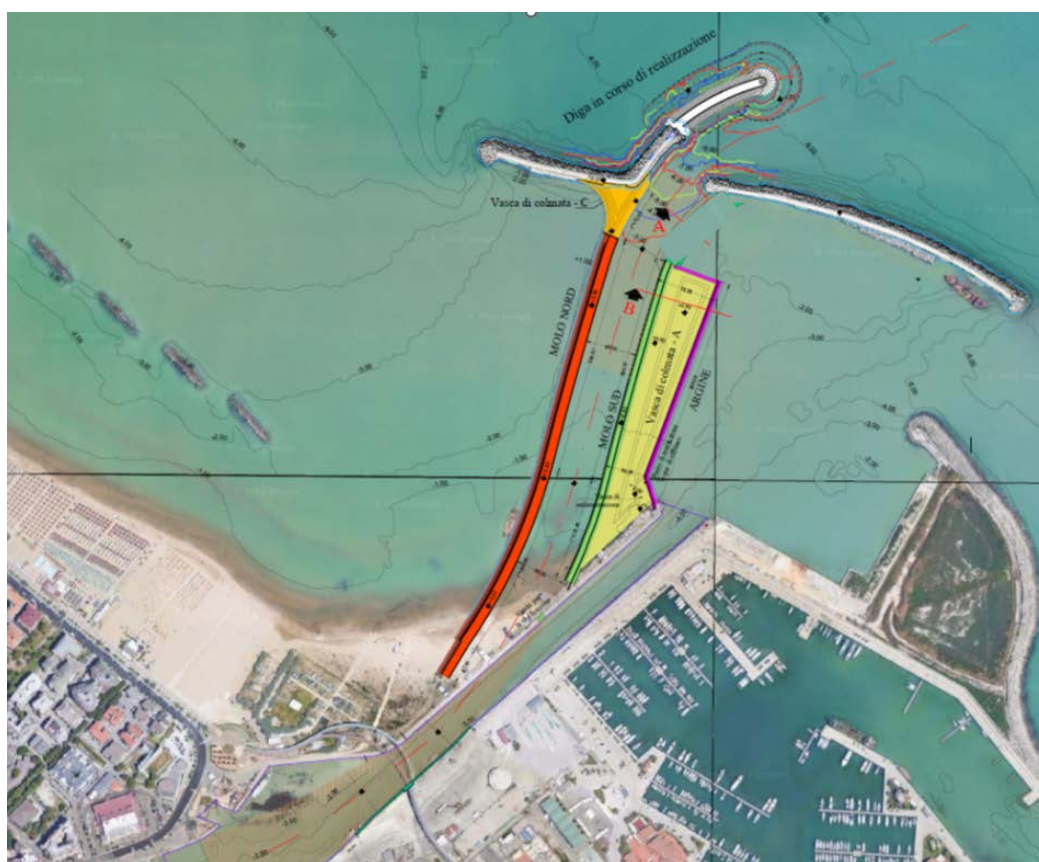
Planimetria con inquadramento delle sezioni Molo Sud
